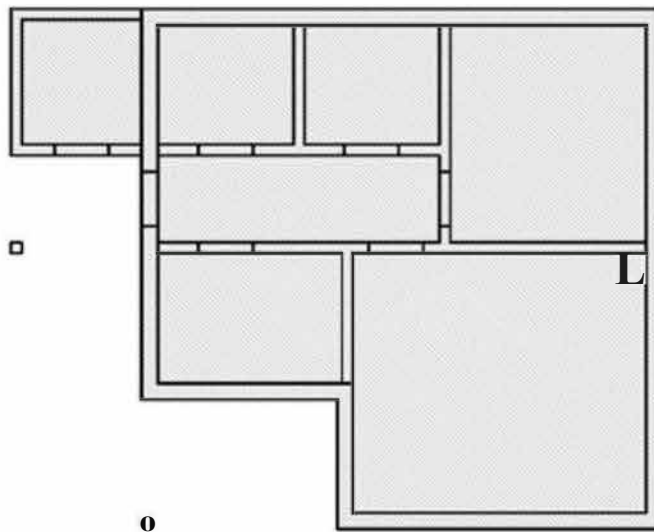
1 - Eksempel på utvendige bygningsarealer (UTA) skravert i plantegning
